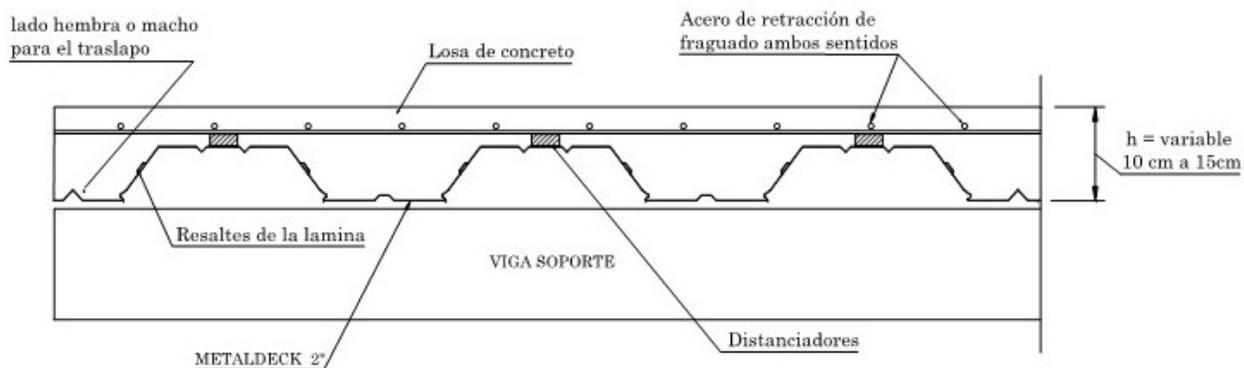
Detalle de losa de entrepiso metaldeck / Fuente: Bibliocad
